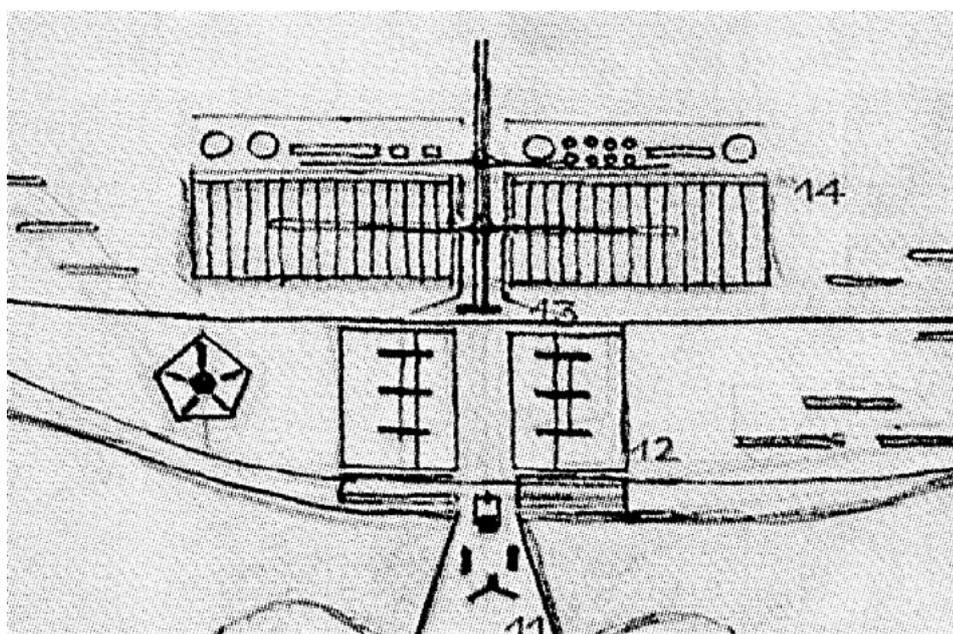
Projeto do Plano Piloto de Brasília com destaque para a praça militar não construída
